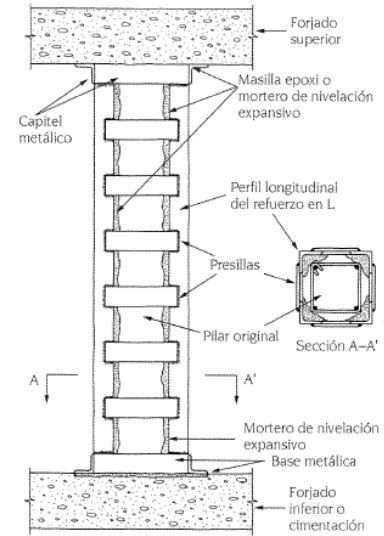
Refuerzo mediante pletinas de acero. www.soloarquitectura.com. Agosto 2017
